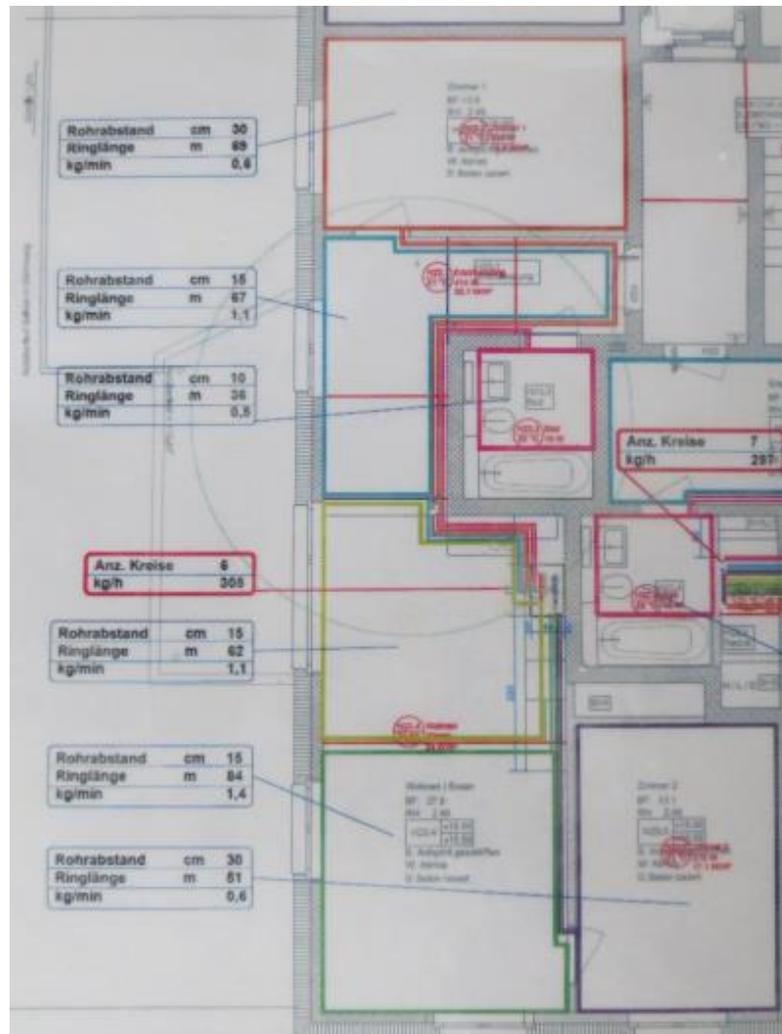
Grundriss Wohnung H23 mit Auslegung FBH
